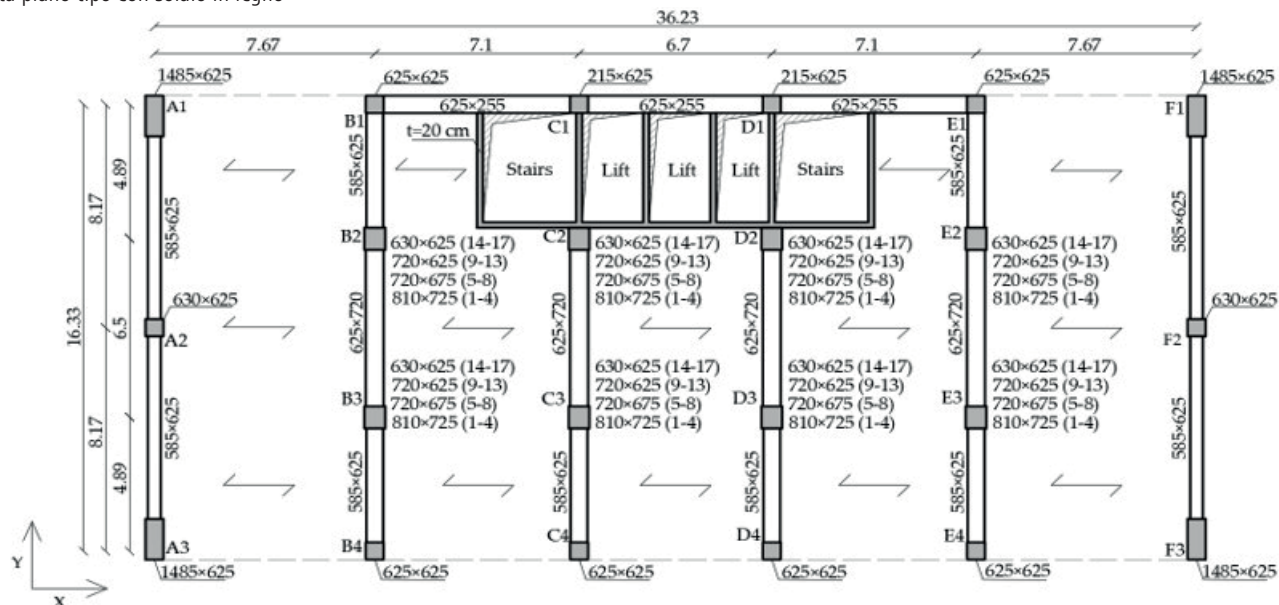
Pianta piano tipo con solaio in calcestruzzo armato
